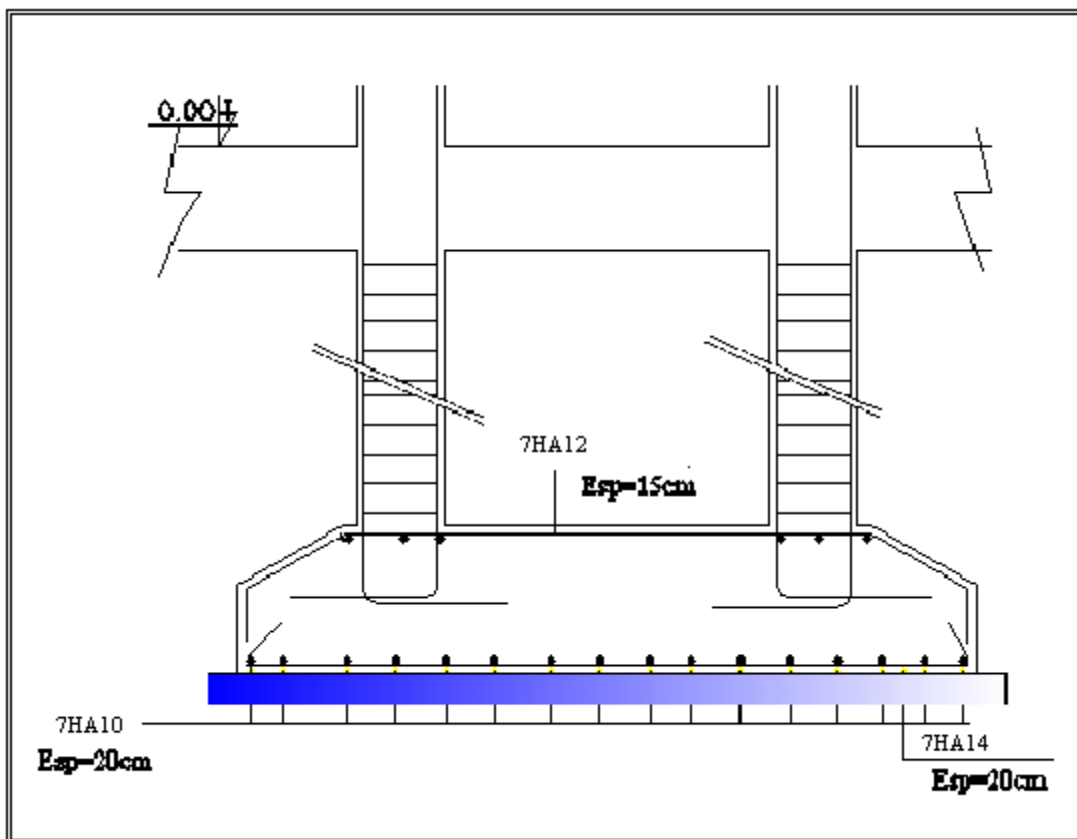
schéma de ferrailage d'une semelle filante sous deux poteaux
